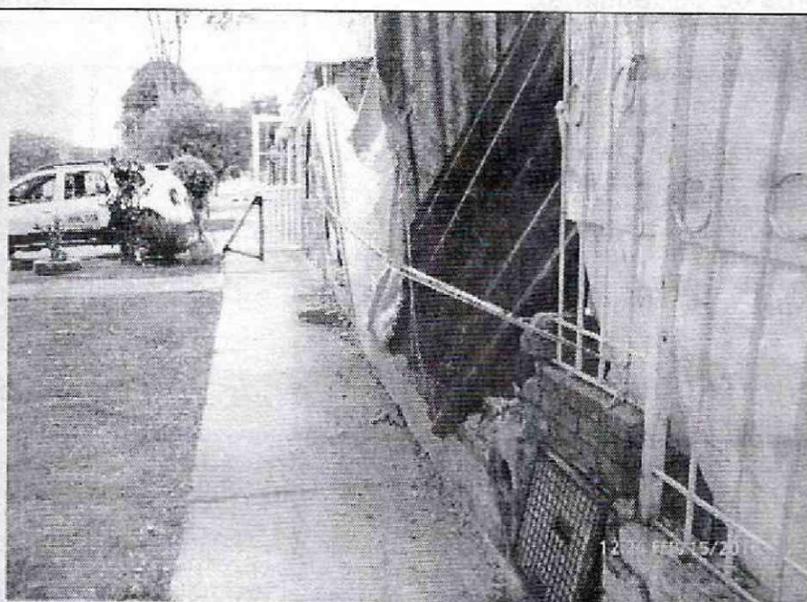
Vista de la vía de acceso a los predio sobre la Carrera 68D donde se observa que el pavimento está siendo afectado por hundimientos y grietas.
